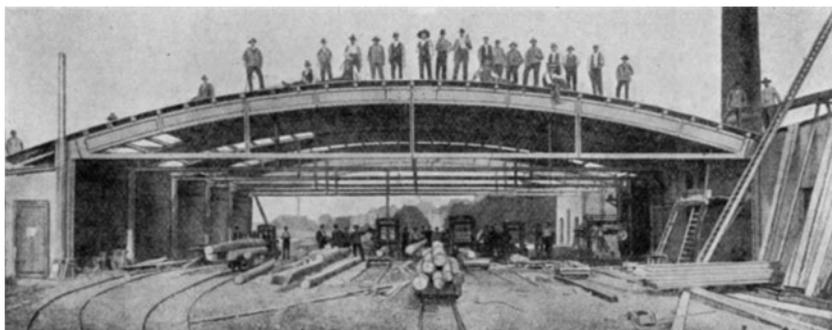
Sägewerkshalle in Beck; erbaut 1911.
